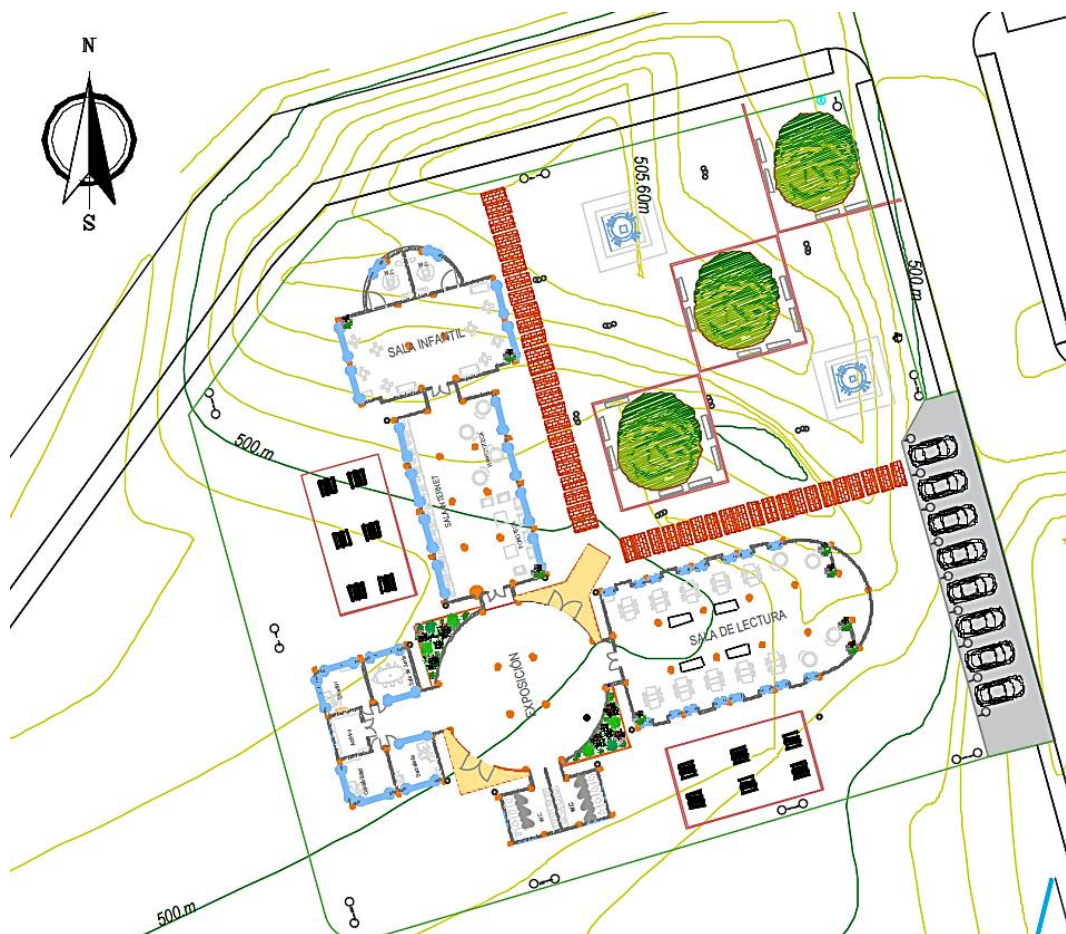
Implantación del plano arquitectónico de la biblioteca en la zona establecida para el proyecto.
